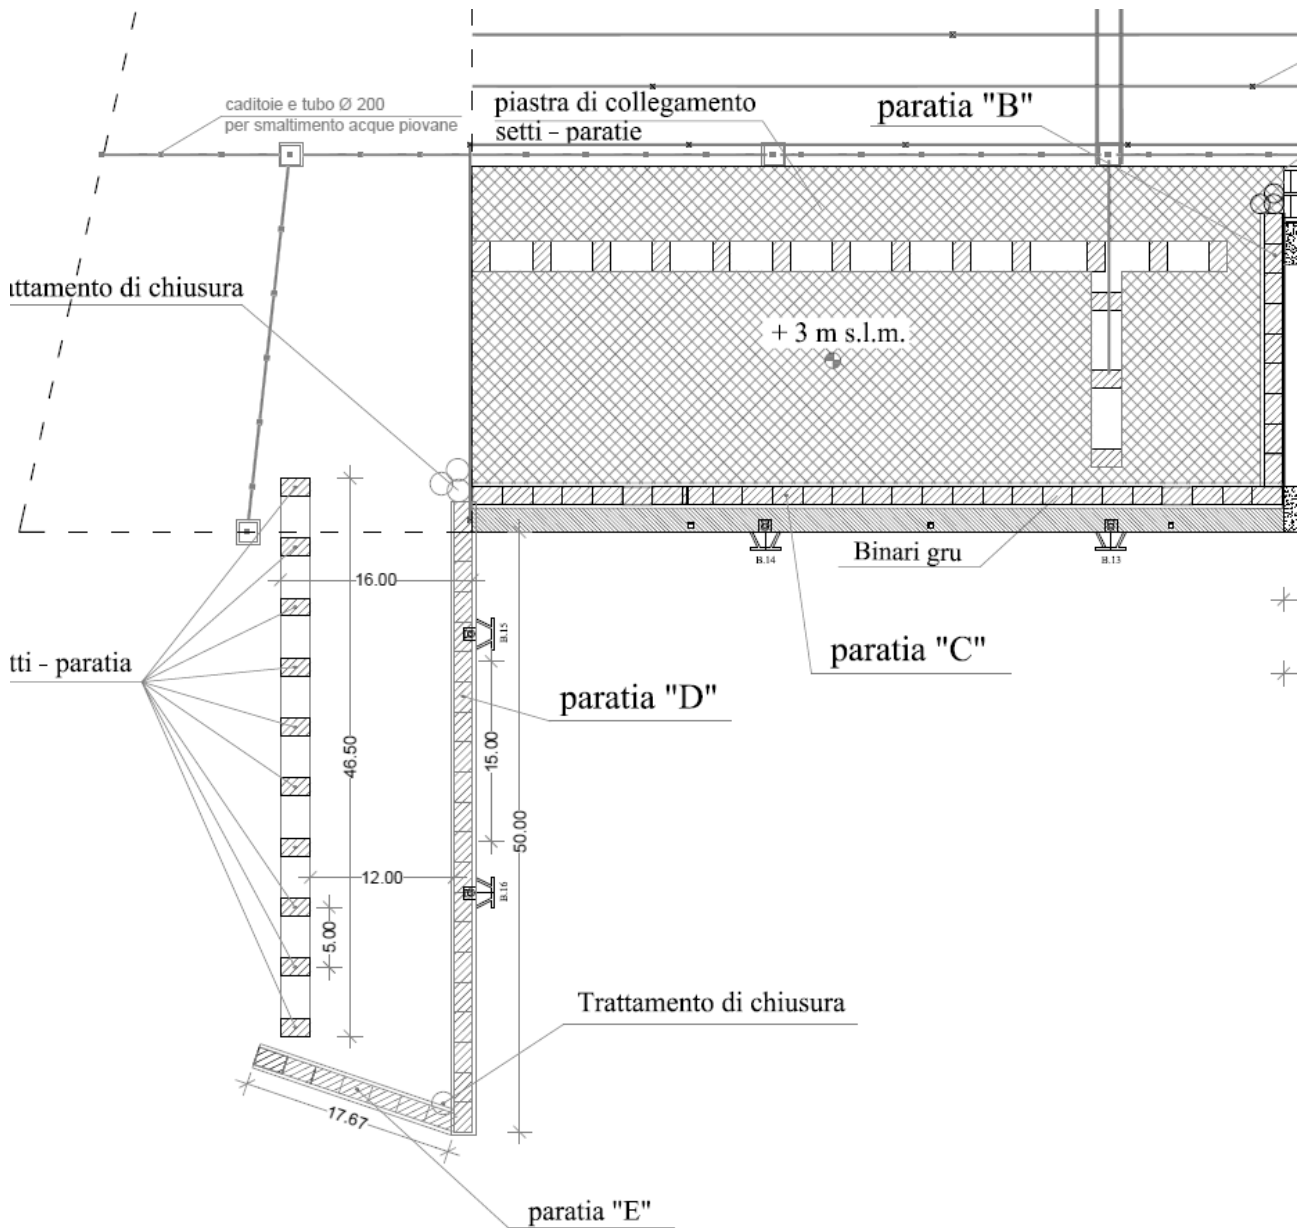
Planimetria dello spigolo ovest del banchinamento F
